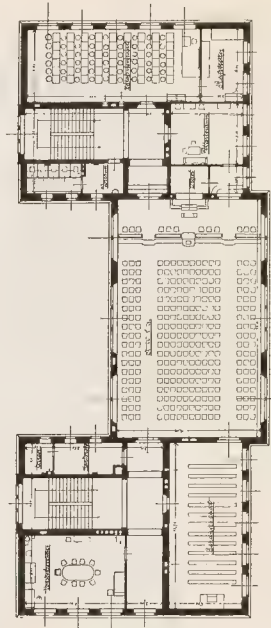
11. Grundrisse des Schulhauses.
